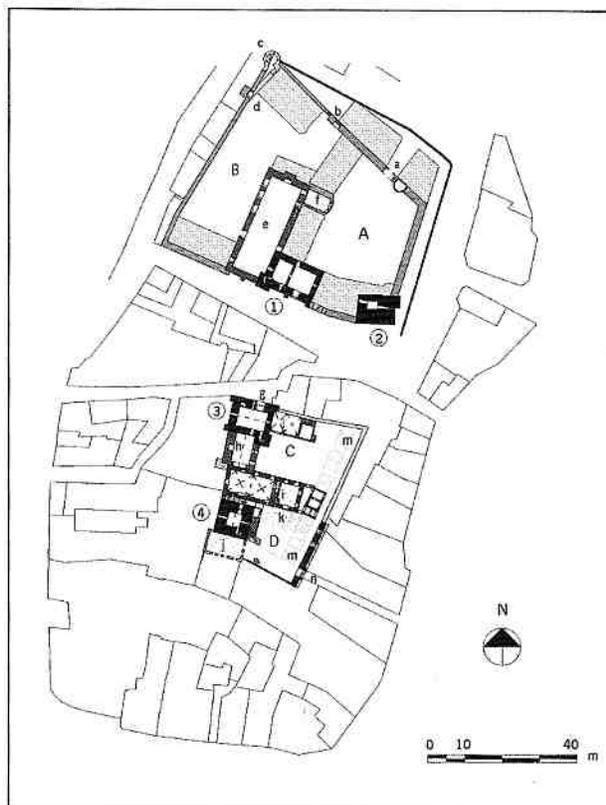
Plan d'ensemble des trois châteaux, reporté sur le plan cadastral moderne.
